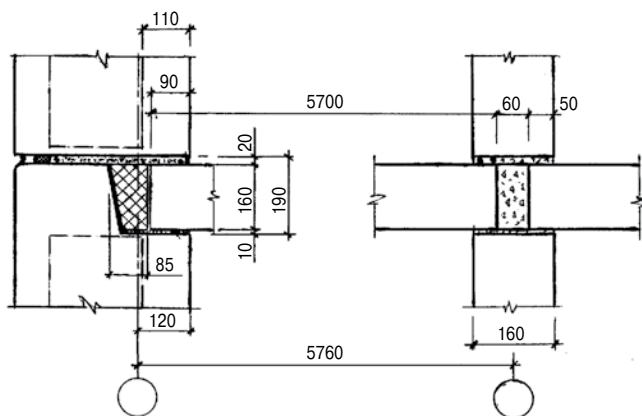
Пример существующей схемы опирания плит перекрытия на продольные стены; ширина площадки опирания на наружные продольные стены – 90 мм, на наружные поперечные – 70 мм
